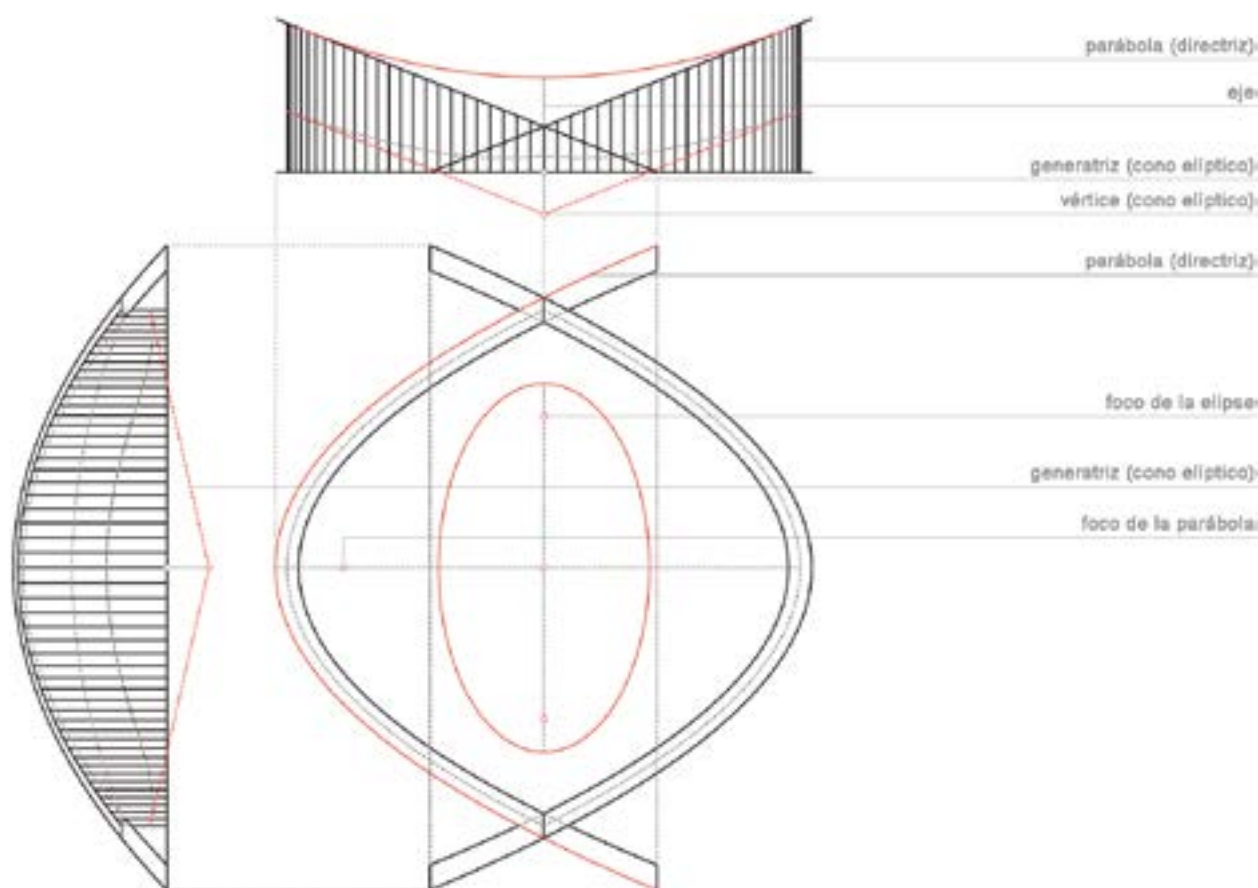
Esquema de alzados y planta del estadio Dorton Arena. Dibujo de los autores.
